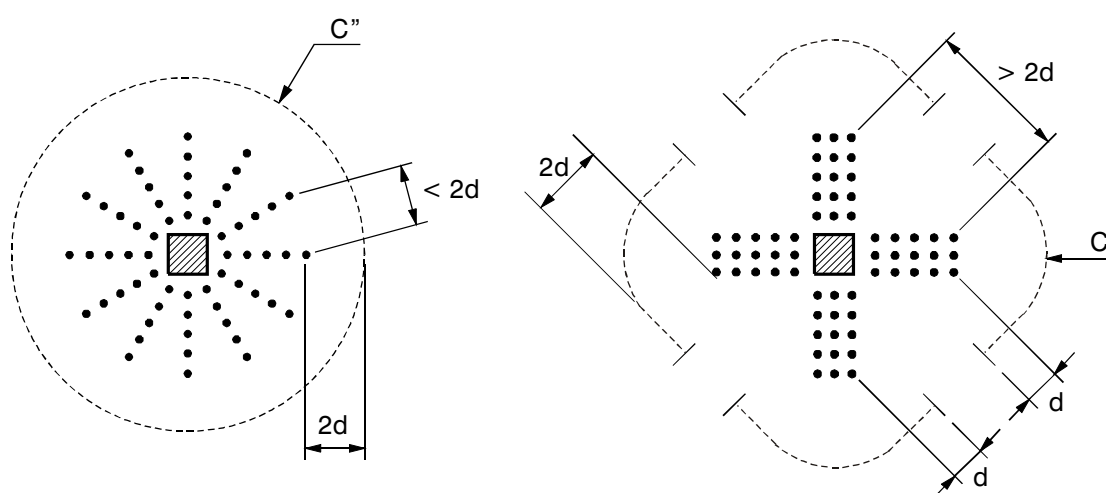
Perímetro crítico externo à armadura de cisalhamento segundo a NBR 6118:2003
